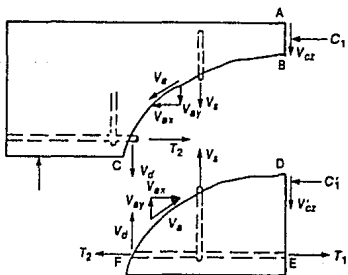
Fuerzas internas en una viga agrietada con estribos (Ref. 3)
